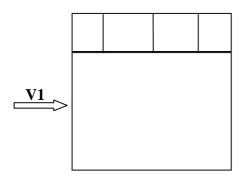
Vent sur la façade principale et secondaire du hangar.
